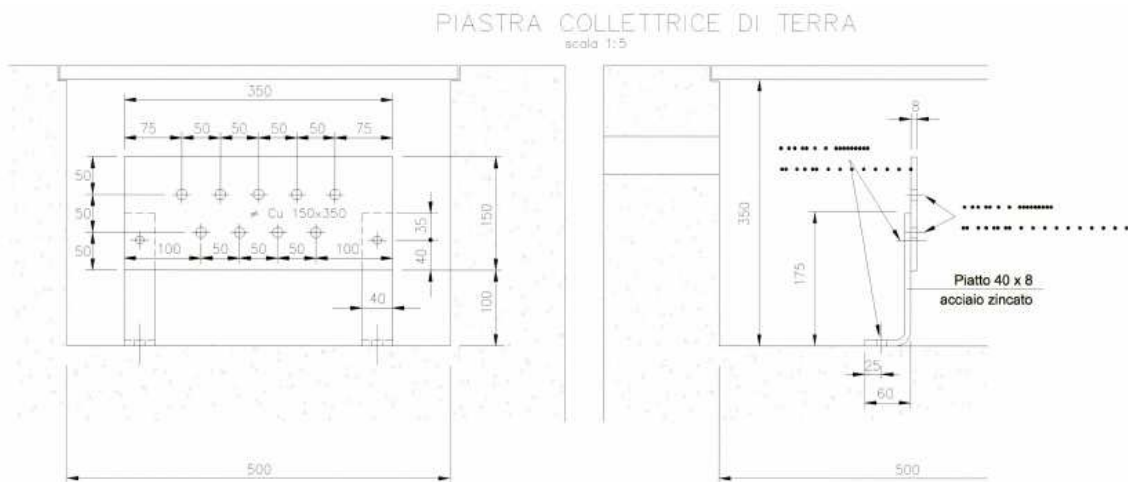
Piazzole BTS: geometria connessione a terra shelter
